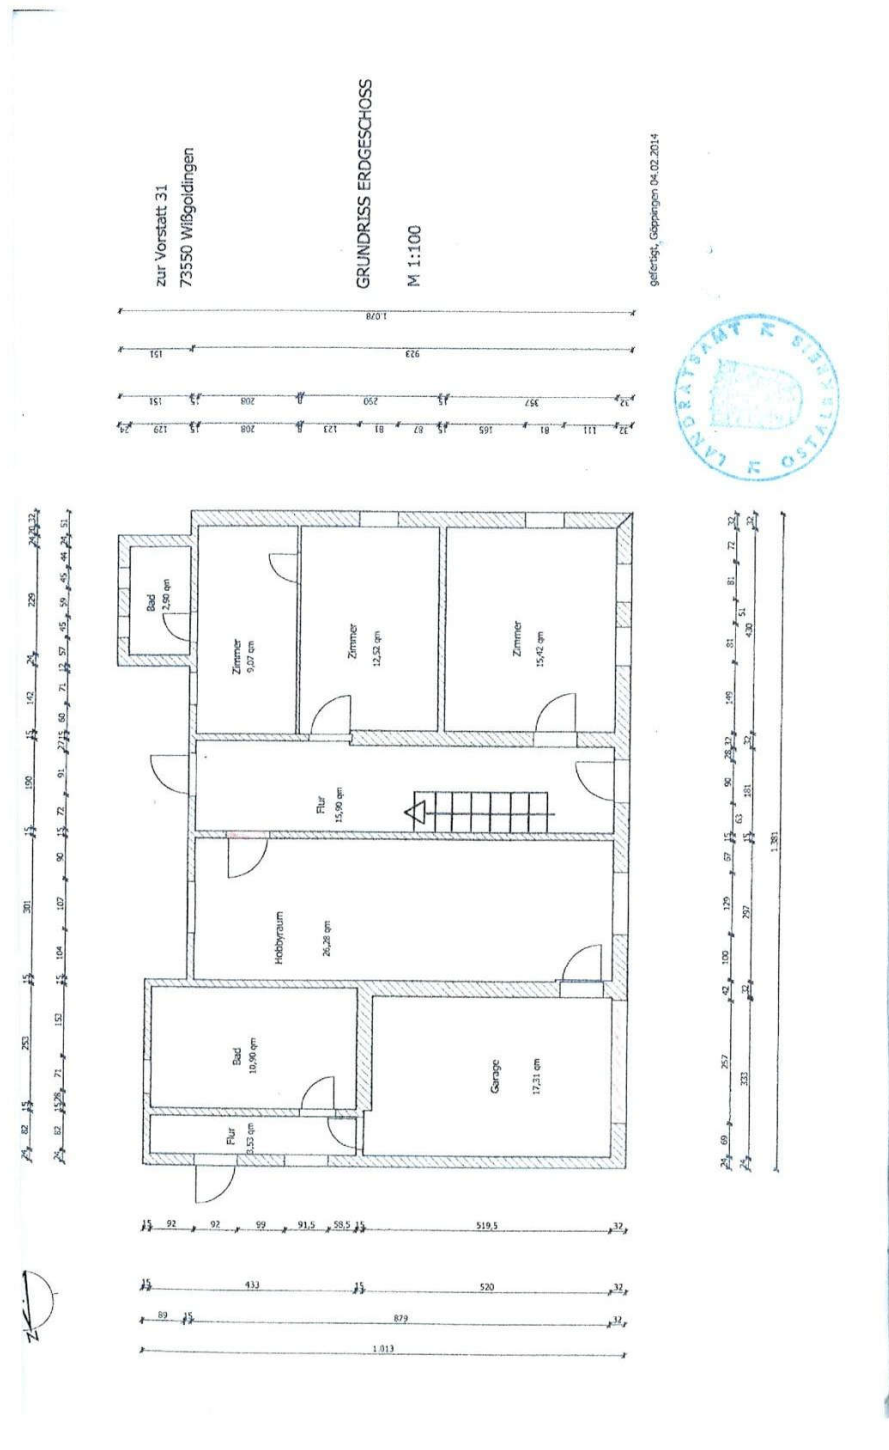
EG nach Umbau (Baugenehmigung vom 27.03.2014)
